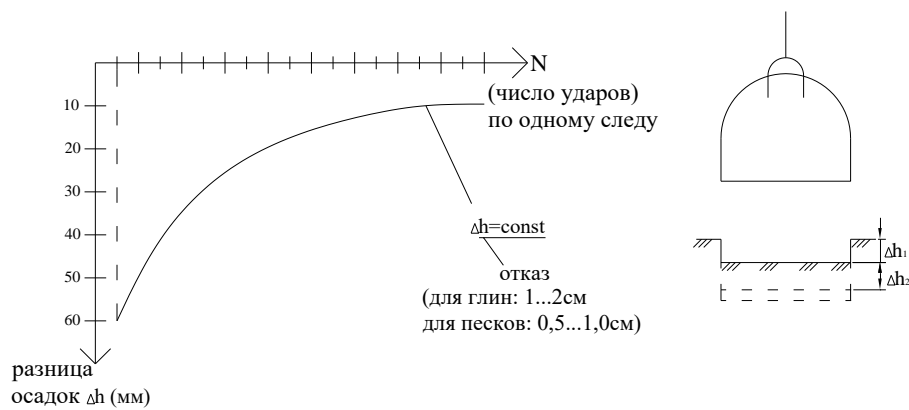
Схема поверхностного уплотнения грунта тяжелой трамбовкой.
